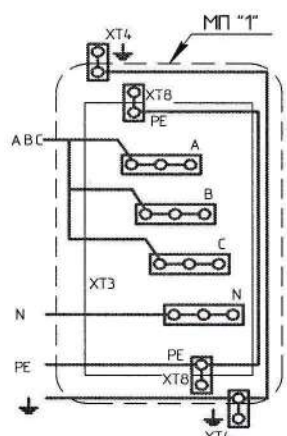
Модуль присоединительный для ЩОВ-XX1Б
